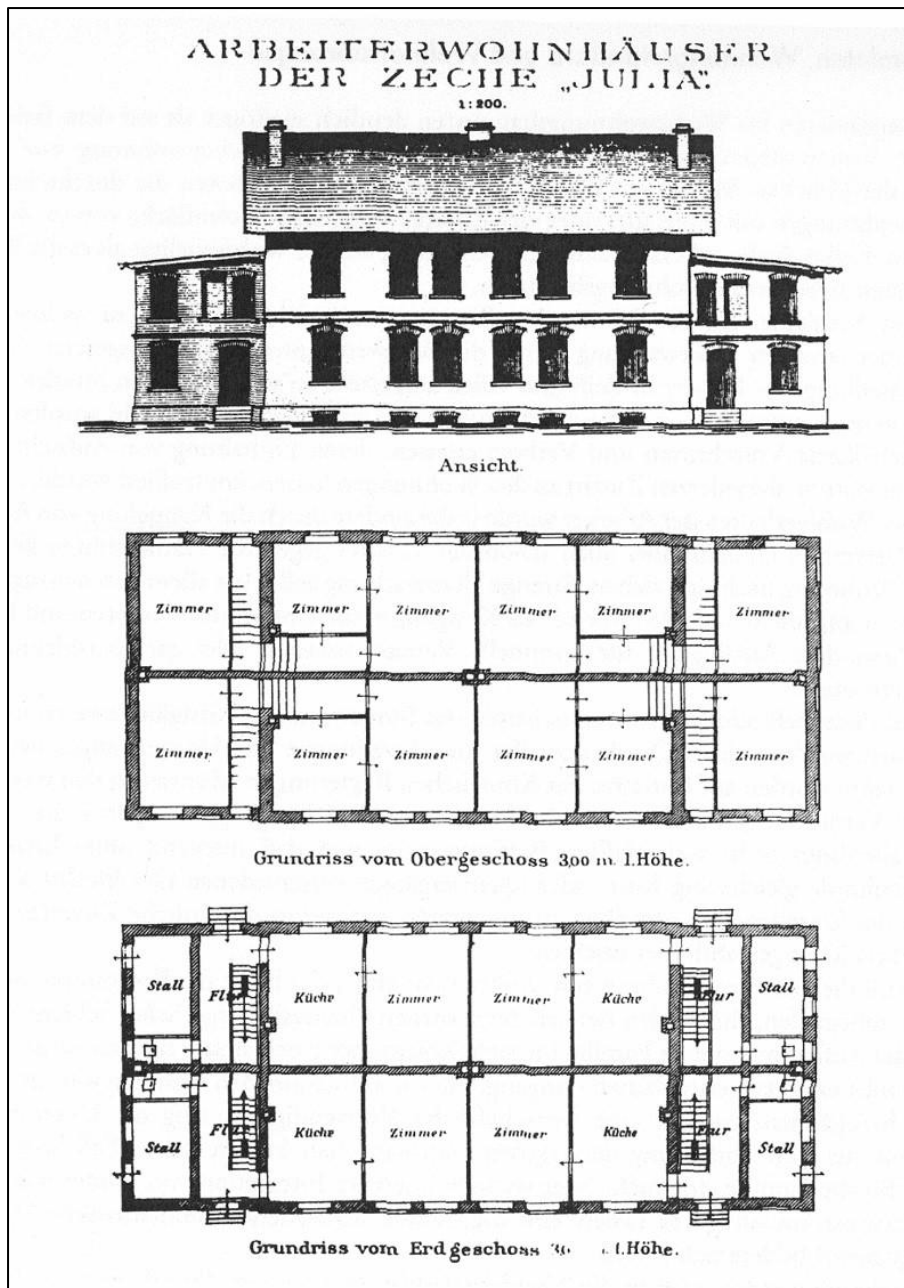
Grundriss des Haustyps der Kolonie Julia (1899). Der Kreuzgrundriss hielt dabei für jede Familie einen separaten Hauseingang mit Flur sowie Stall und Klosett vor. Das Haus war vollständig unterkellert sowie an die Wasserver- und Abwasserentsorgung angeschlossen. Es bot jeder Familie neben einer Küche fünf Zimmer auf 81,5 m². Weiterhin erhielt jede Familie ein Stück Garten zur eigenen Nutzung. (Quelle: CLARKE 2009², S. 87).
